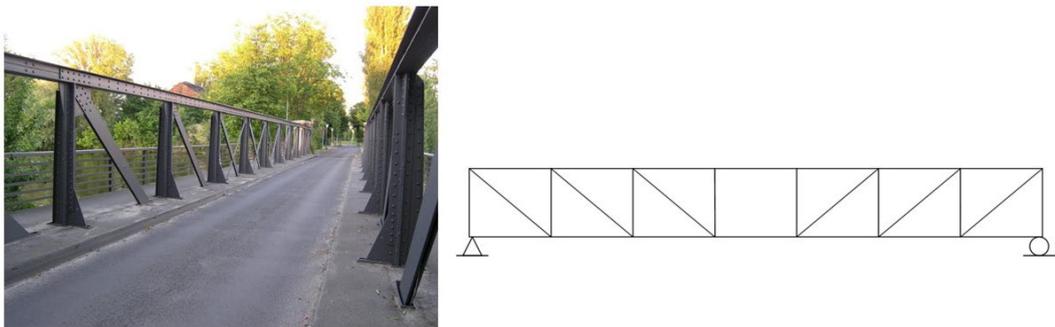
Poutre en treillis métallique de la passerelle ¹³¹
